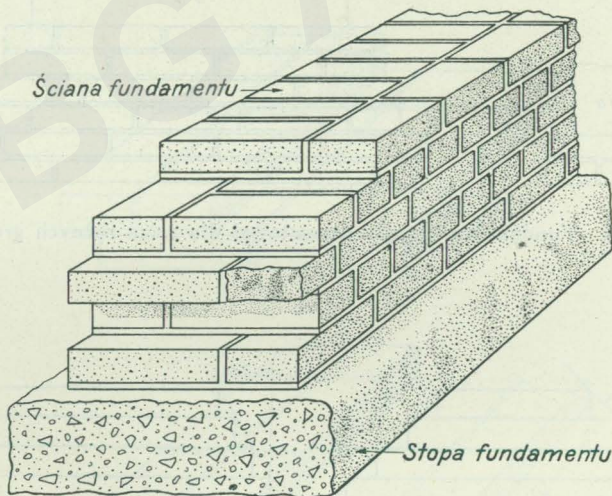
Fundamenty z cegły cementowej dla ścian różnych grubości.
